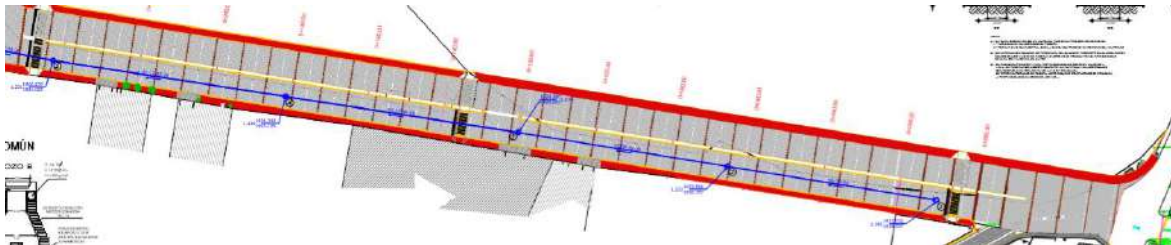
Localización de red de drenaje sanitario. Plano de drenaje sanitario de la calle.
